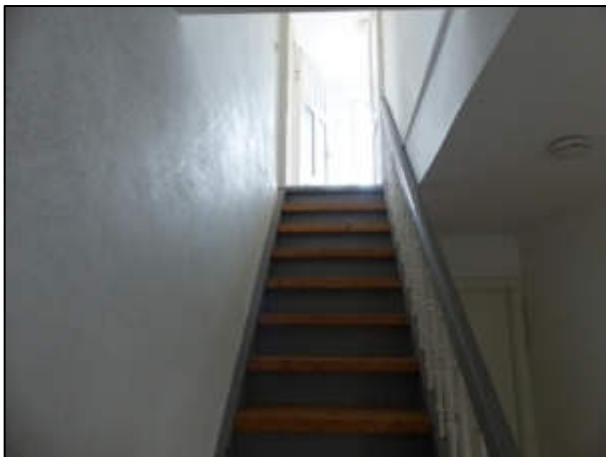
EG – Treppe zum 1. Obergeschoss (OG)
